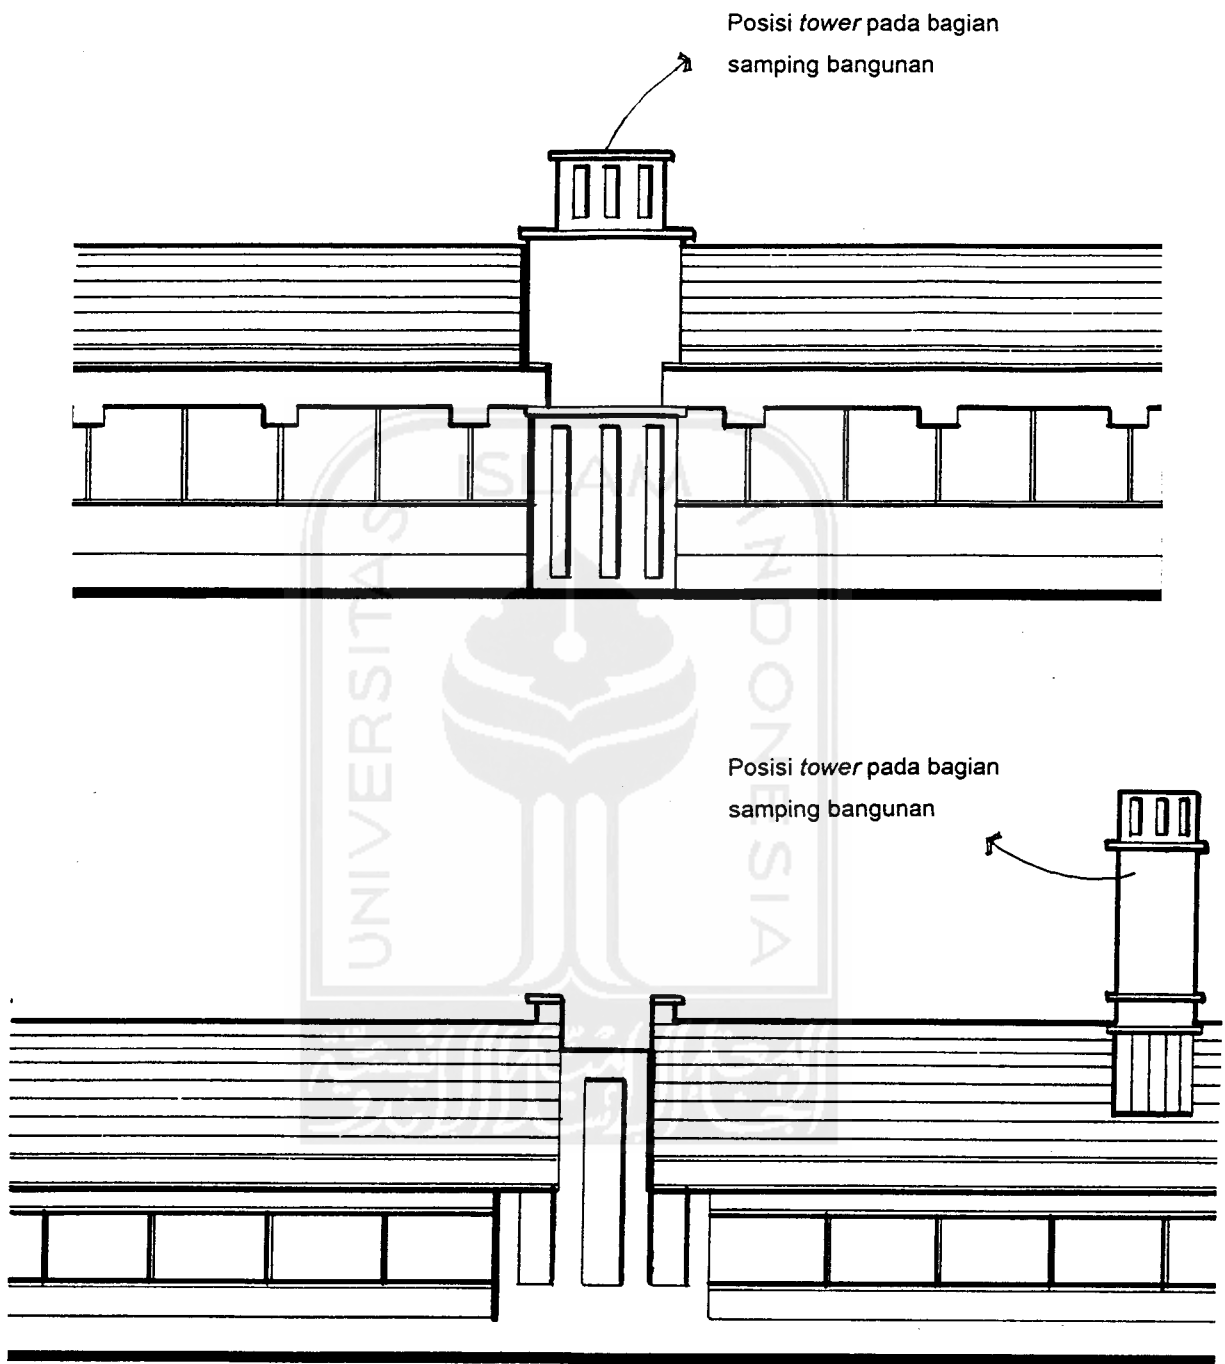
Penggunaan Tower pada De Gereformeerde Kerk di Surabaya
